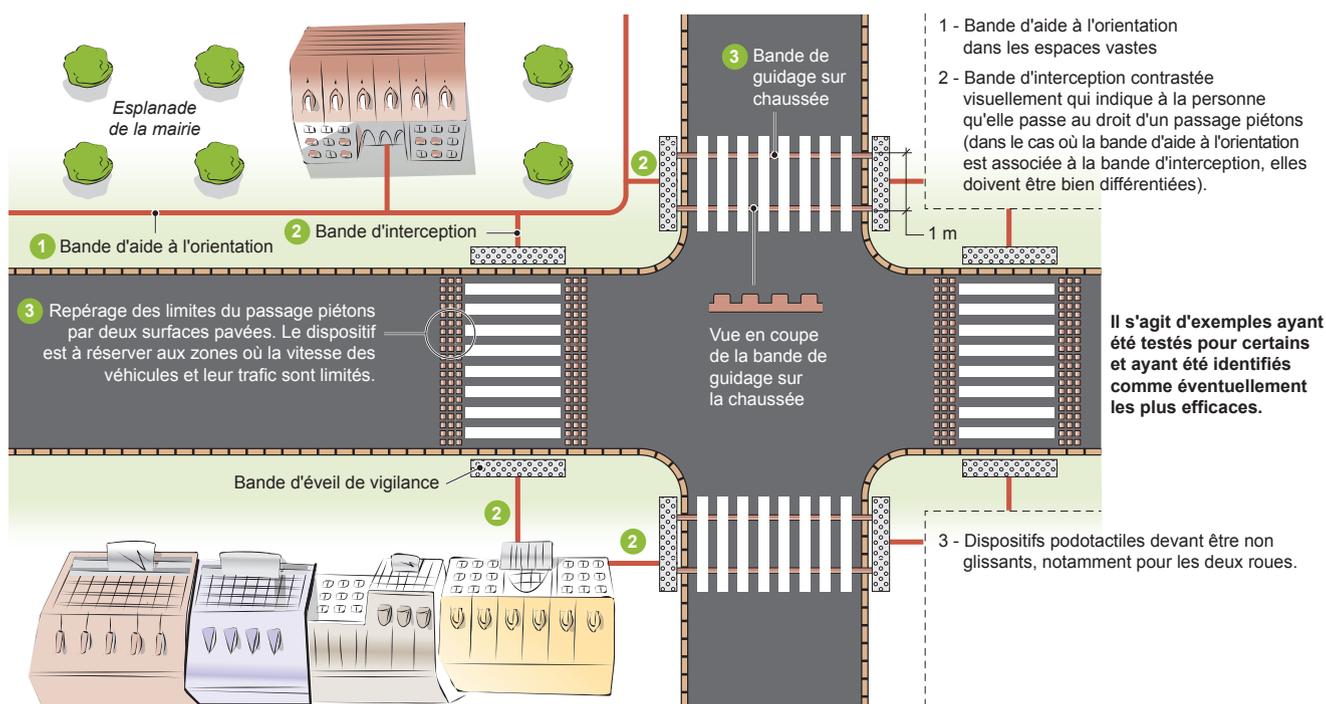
Mise en place de bandes d'aide à l'orientation sur les trottoirs et les traversées de chaussée.
